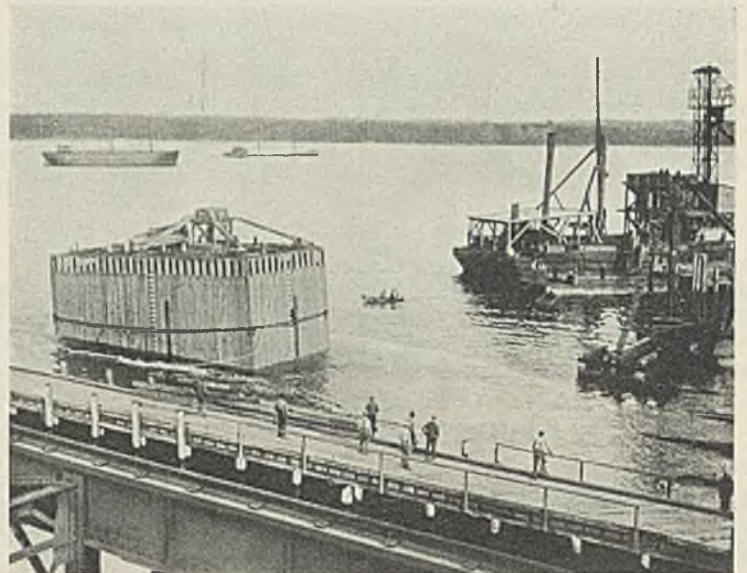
Der Senkkasten wird im Wasser zum Verbringen an die Baustelle flott gemacht.
